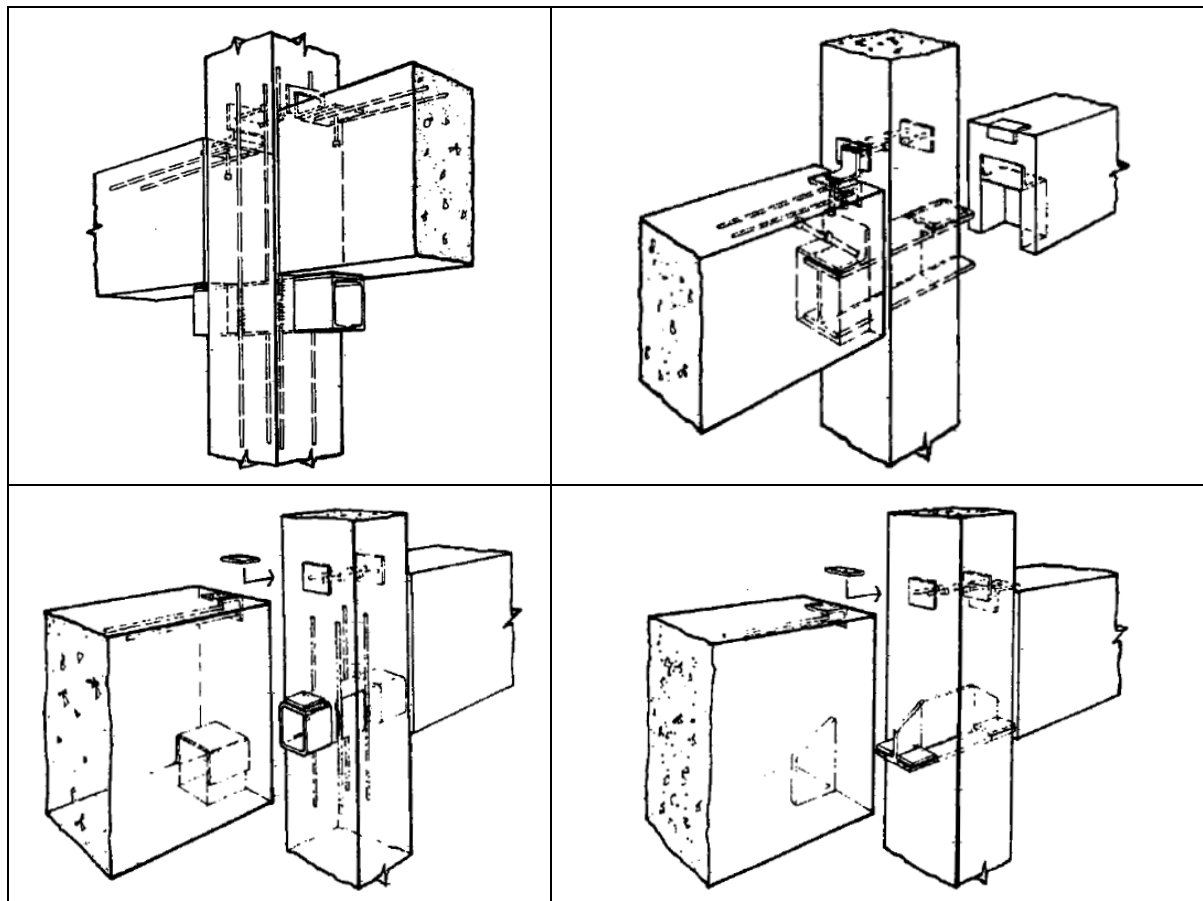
Ligações pilar-viga por perfis de aço (PCI, 1999)
